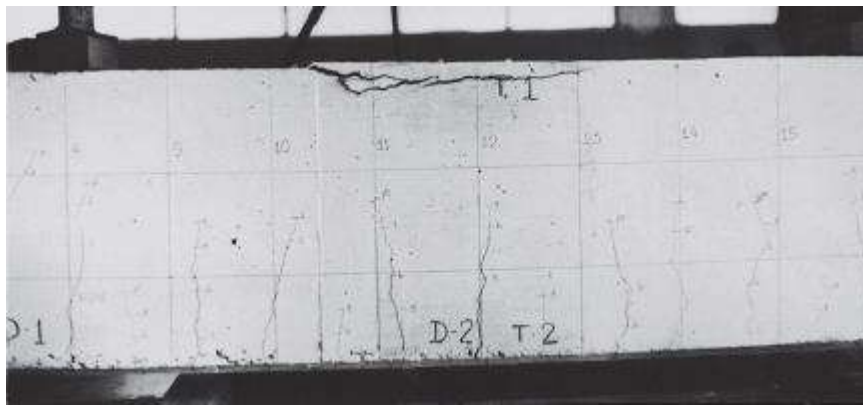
Fissuras em face inferior de viga submetida à flexão
